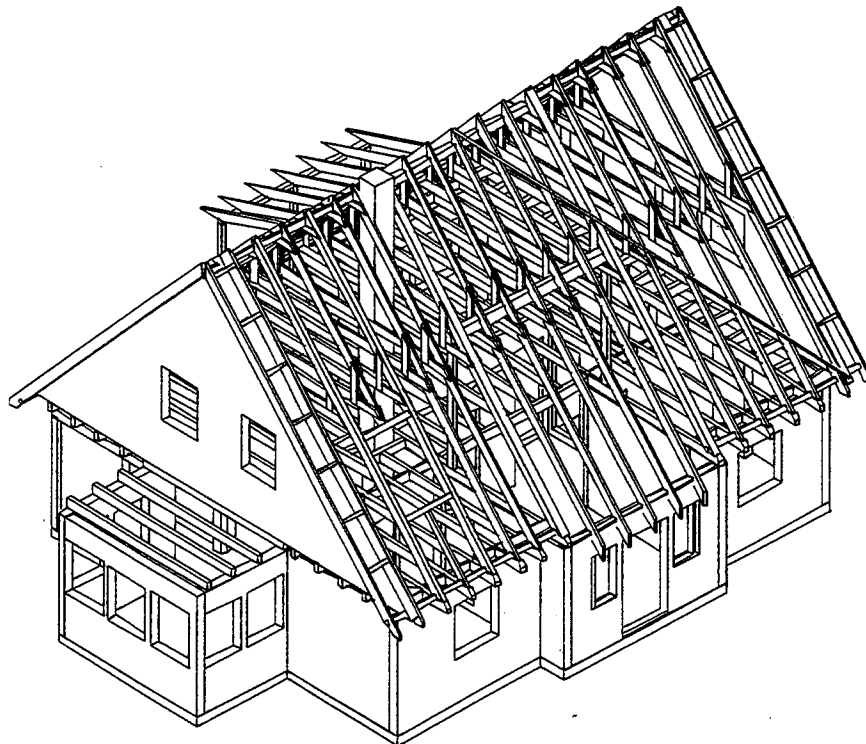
Isometrie eines Holzhauses (Decken und Dach ohne Beplankung)
